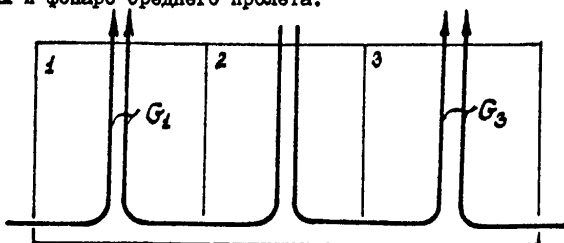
Схема аэрации трехпролетного здания с приточными проемами, расположенными в наружных стенах крайних пролетов и поступлении воздуха через фонарь среднего "холодного" пролета
